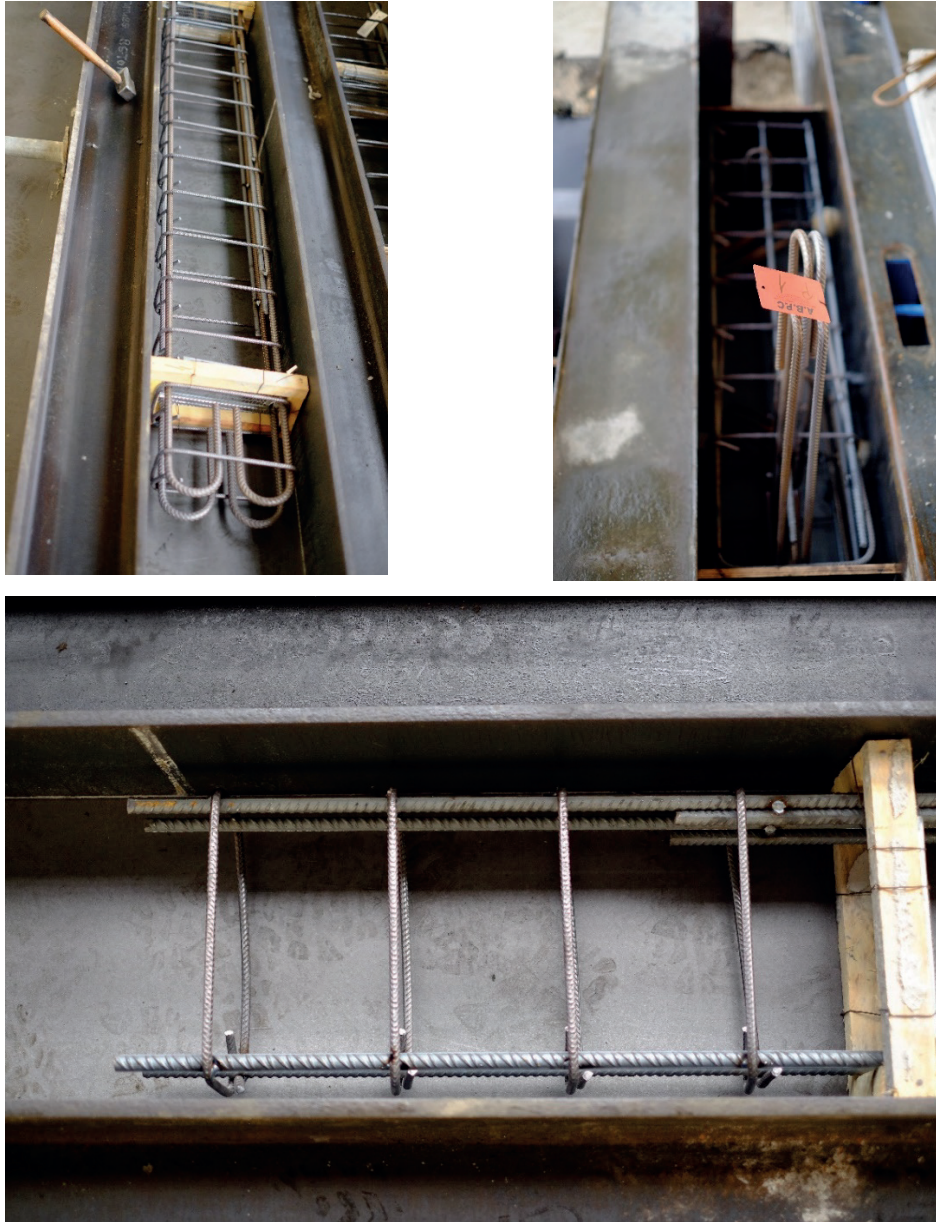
Contrôle du ferrailage et de l'arrêt du béton aux zones de clavetage.
